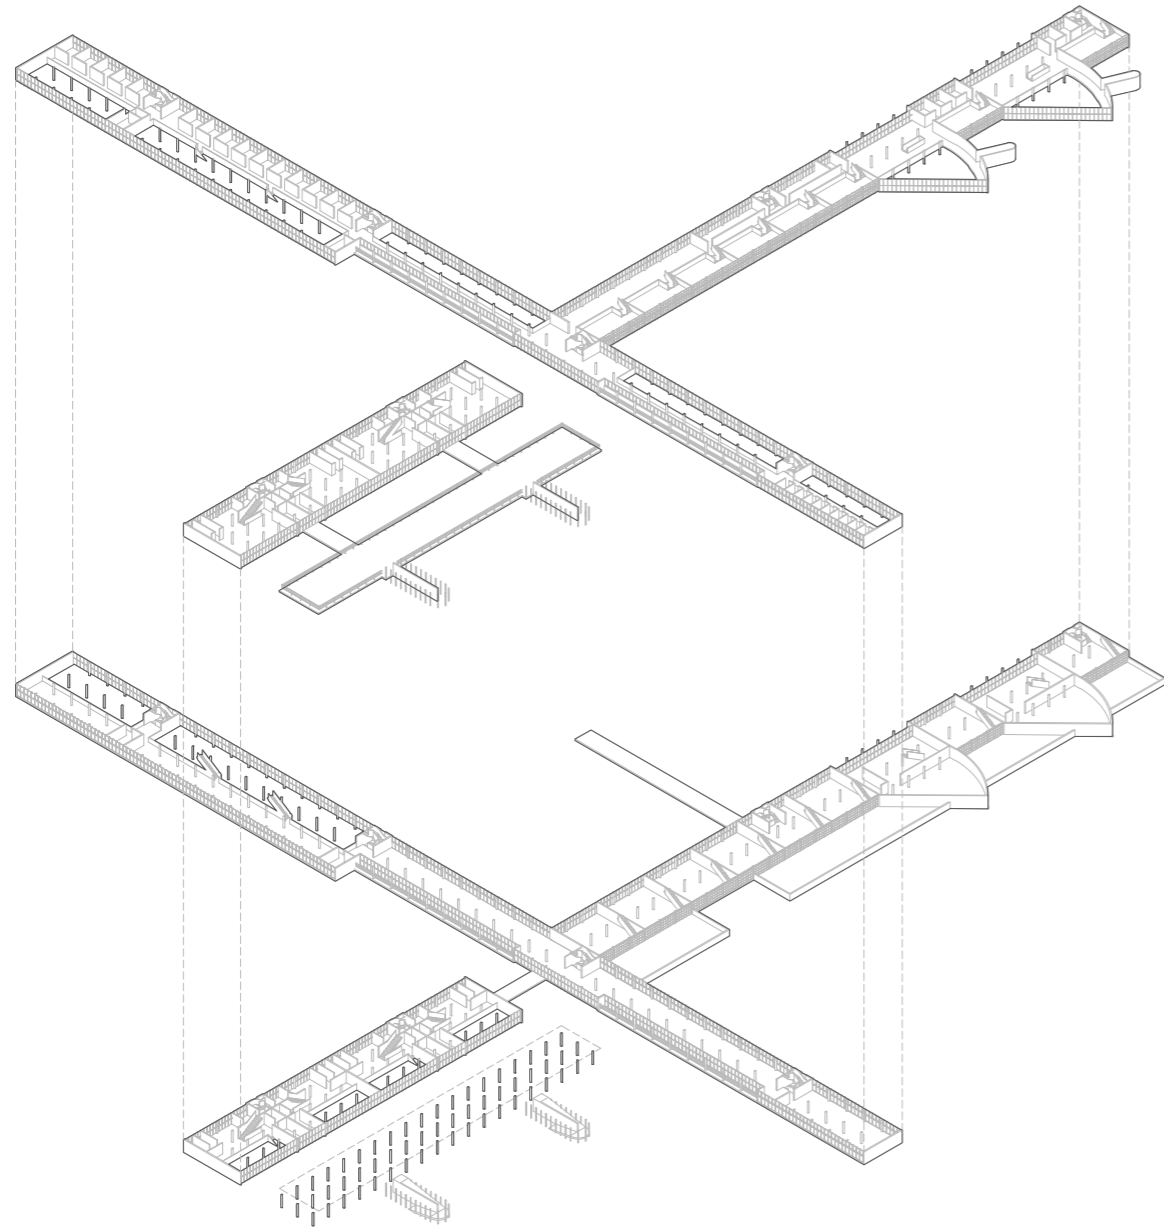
Axonometría seccionada a nivel. Planta segunda y tercera.
